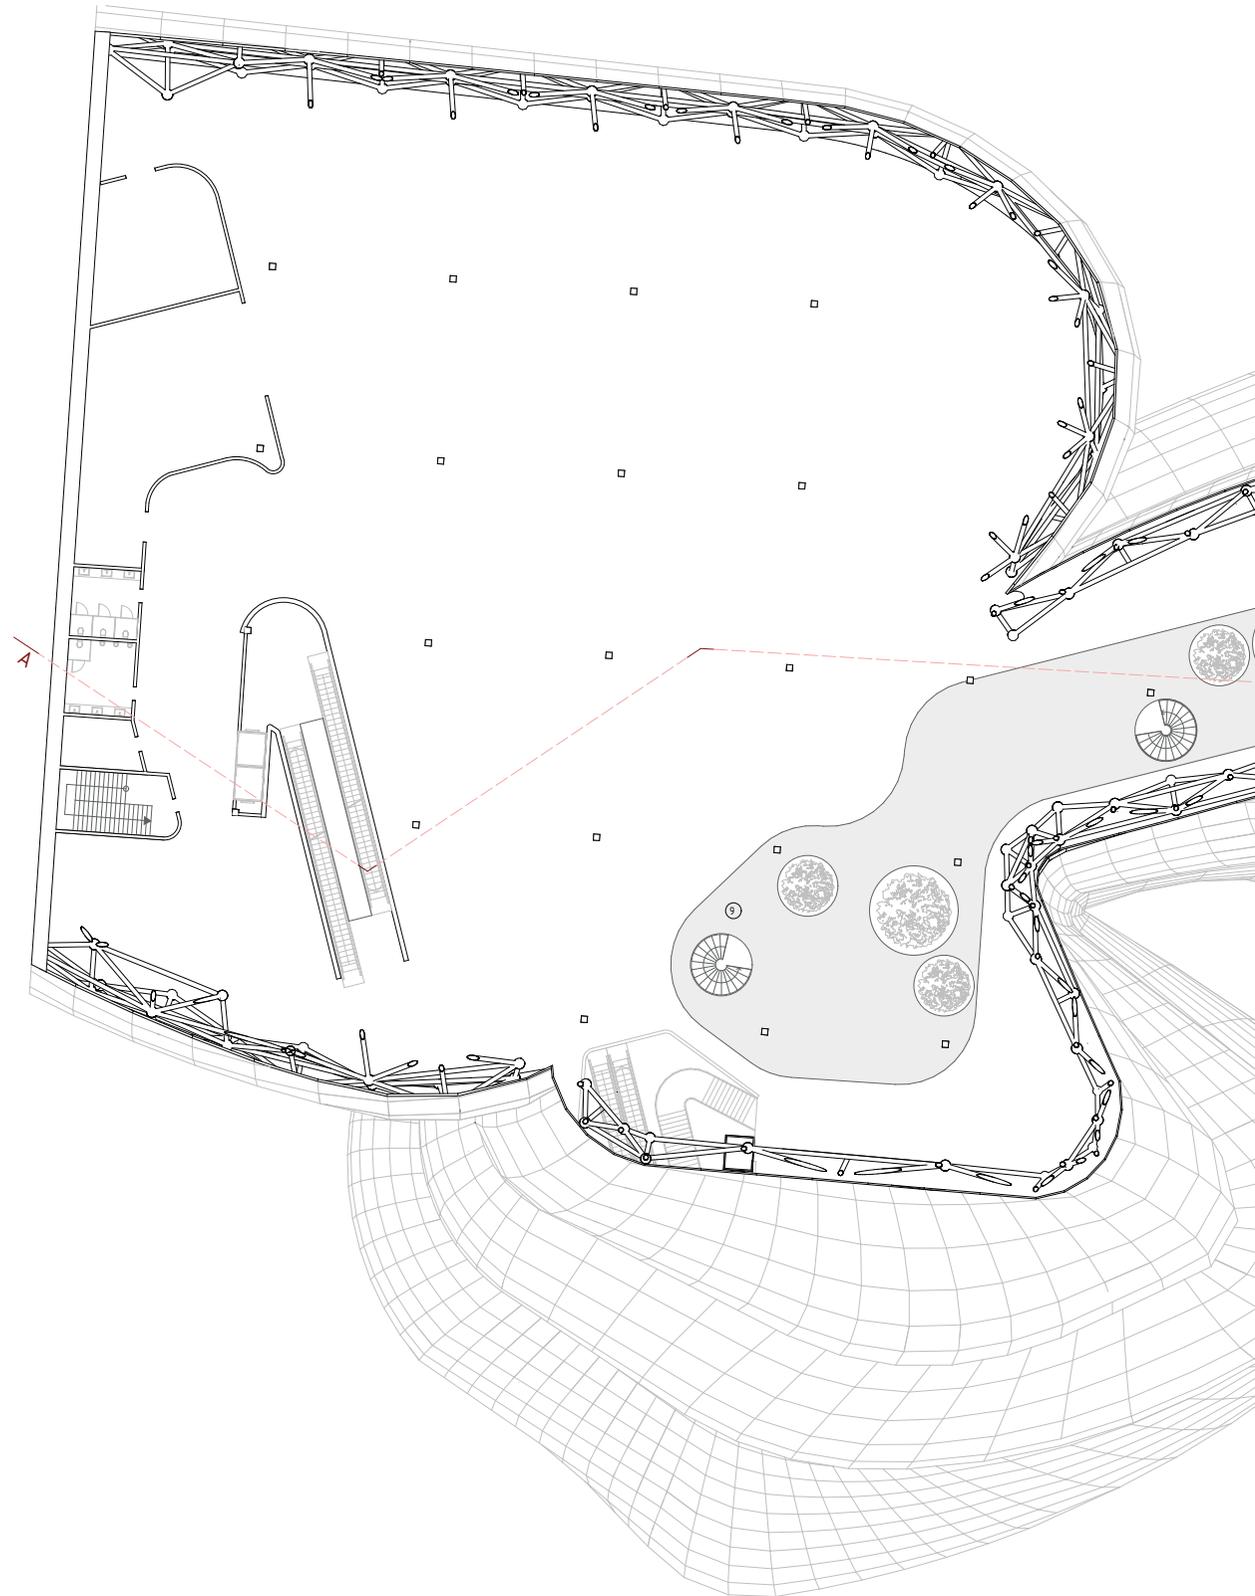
Grundriss 3.Untergeschoss
